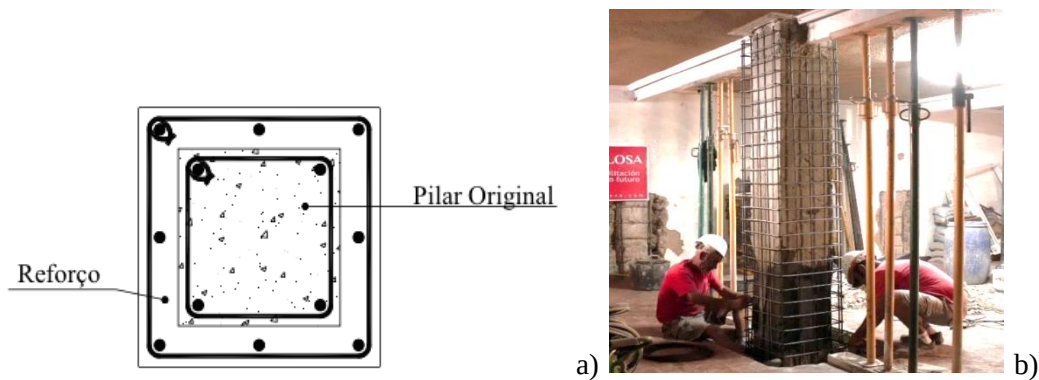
Reforço de pilar por encamisamento de betão armado: a) Esquema de armaduras de reforço; b) Aplicação a caso concreto (Bousias et al., 2005).
